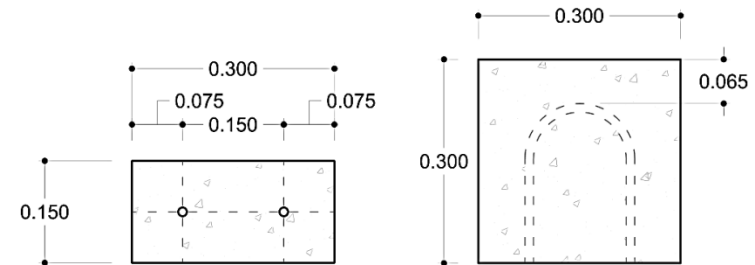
Distancia a la que se coloca la tubería en el prototipo. Fuente: Autoría propia.
